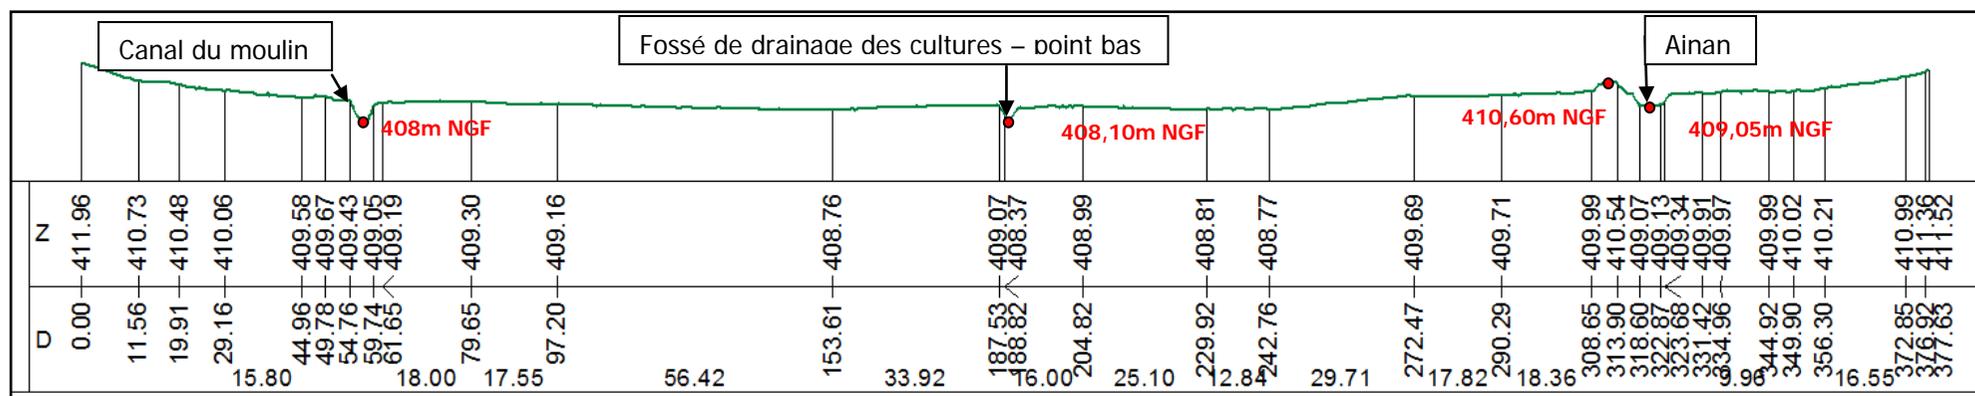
Profil en travers de la plaine alluviale de l'Ainan (Echelle en Z : x3)
